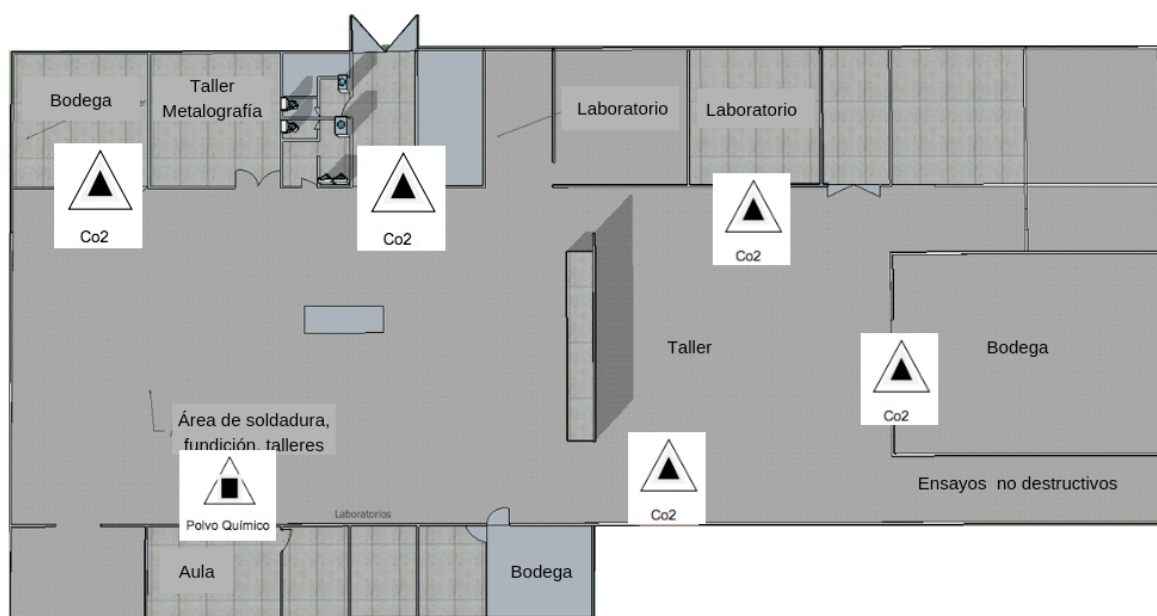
Identificación de extintores para la planta baja del CIEMTEC
